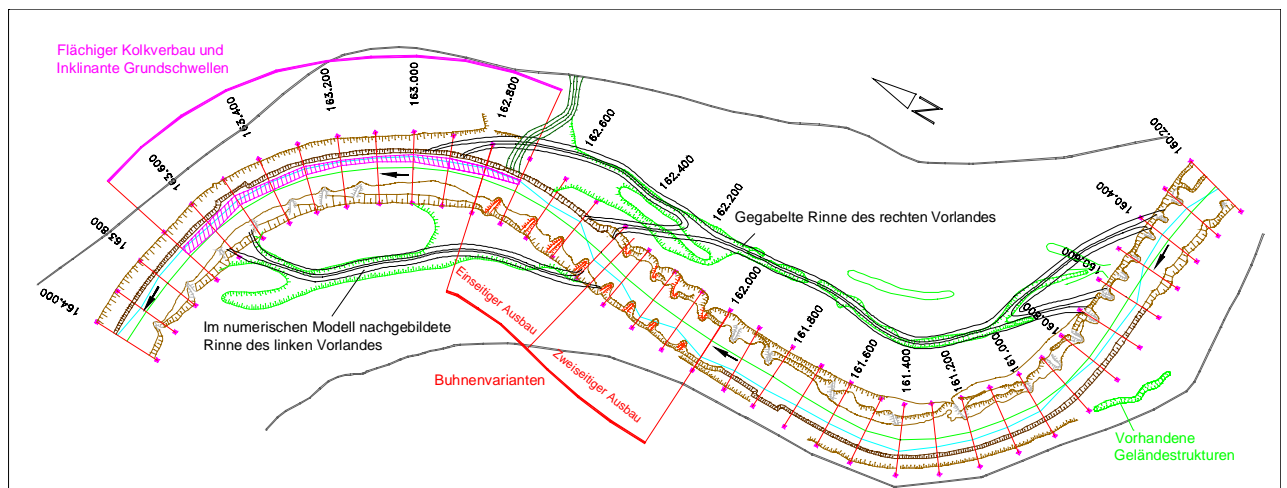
Grundriss des Modells mit Lage der Untersuchungsvarianten
